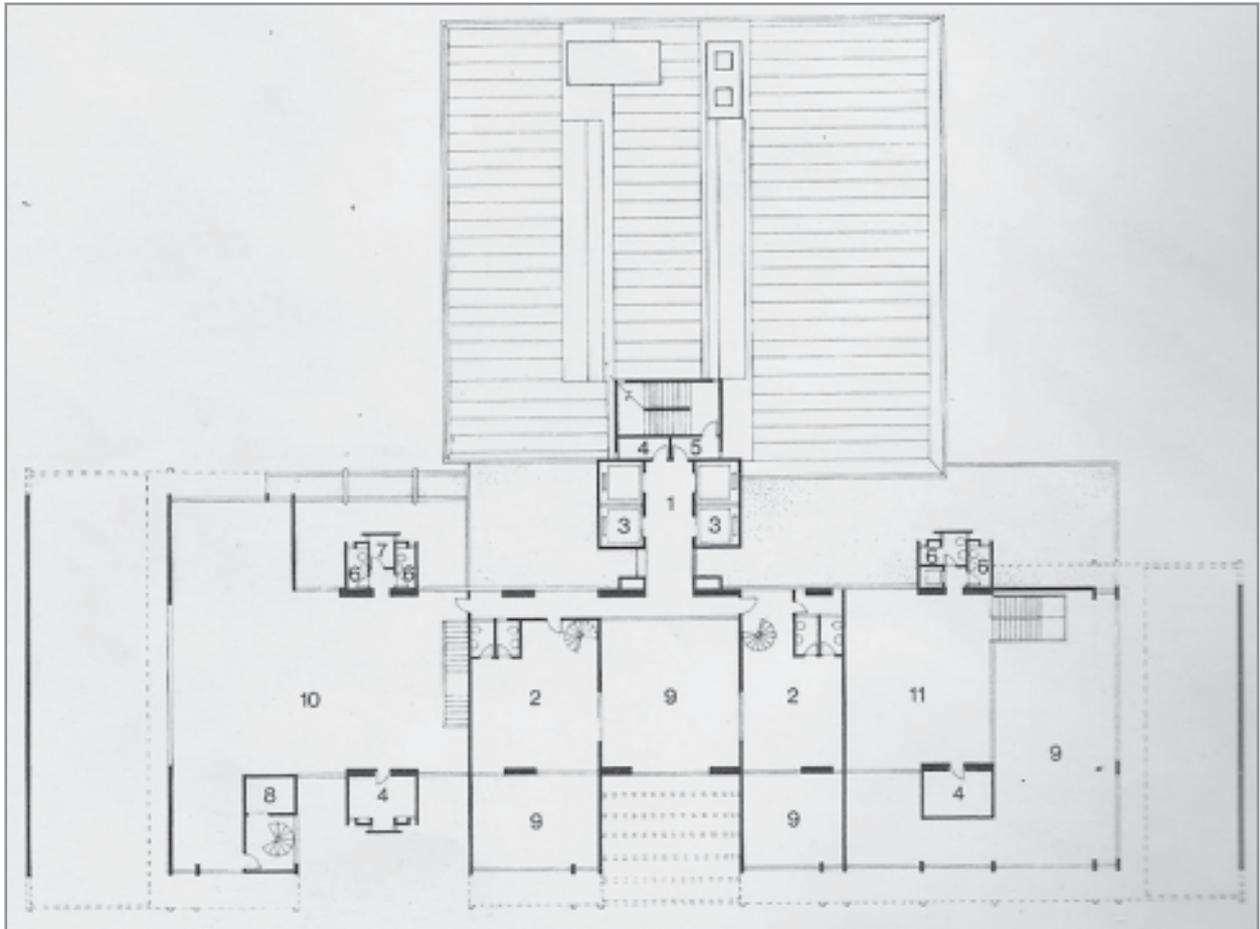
Planta do Pavimento do Mezanino - Fonte: Revista Projeto nº 110, Maio de 1988, página 90.
